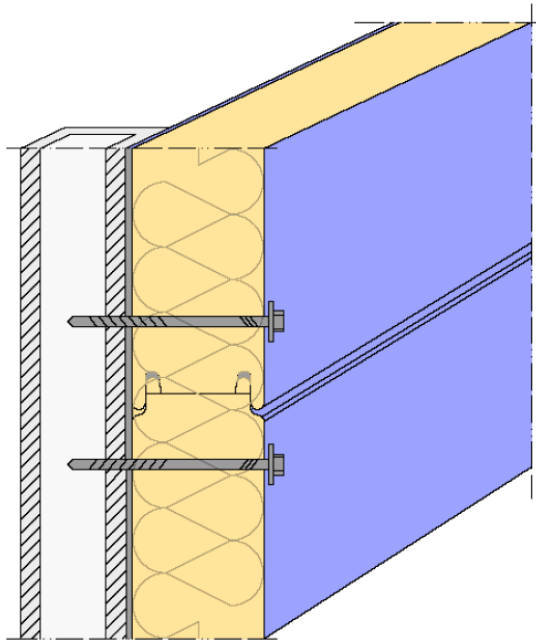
Утеплення фасаду сендвіч-панелями
